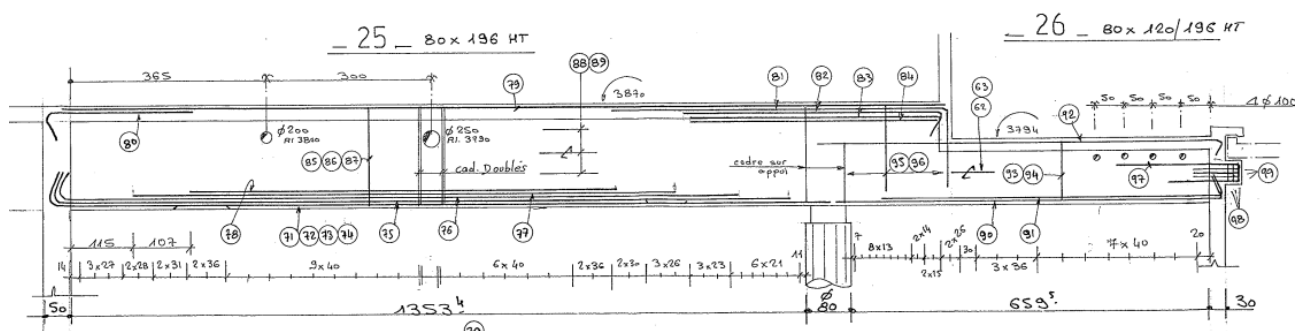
Vigas de hormigón armado 25 y 26. Armado original.
